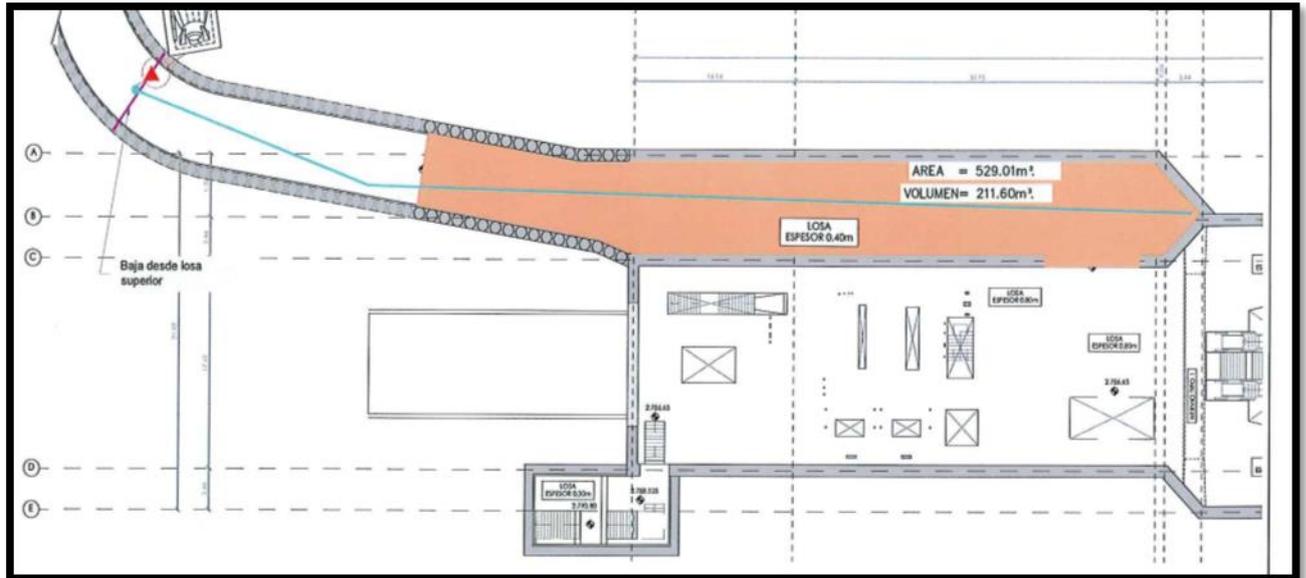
Losa de vestíbulo fase 1 y 2
